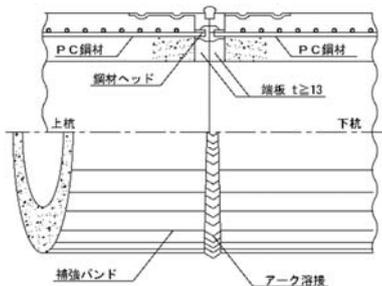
PHC 杭の端板式溶接継手の構造例 (道示IV編, 図-解 10.10.3)
